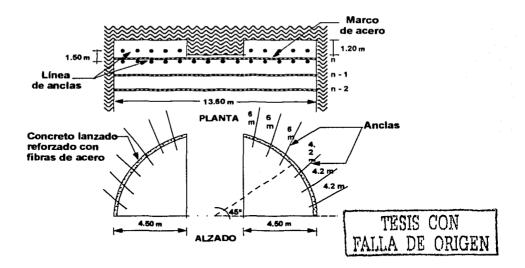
Anclaje de los laterales utilizando elementos de 6 m amba de la inclinación de 45° y de 4.2 abajo
